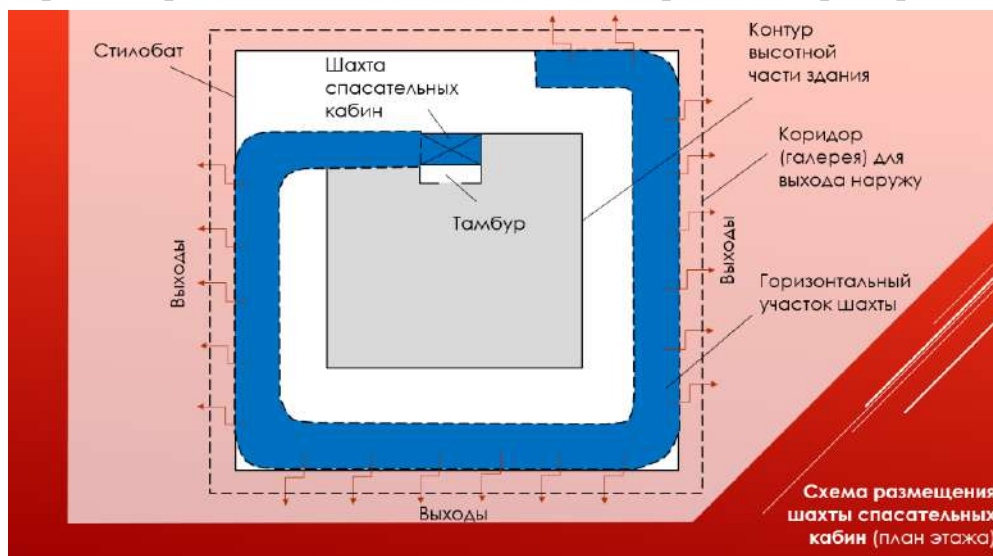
Схема размещения шахты спасательных кабин, разрез, план этажа
